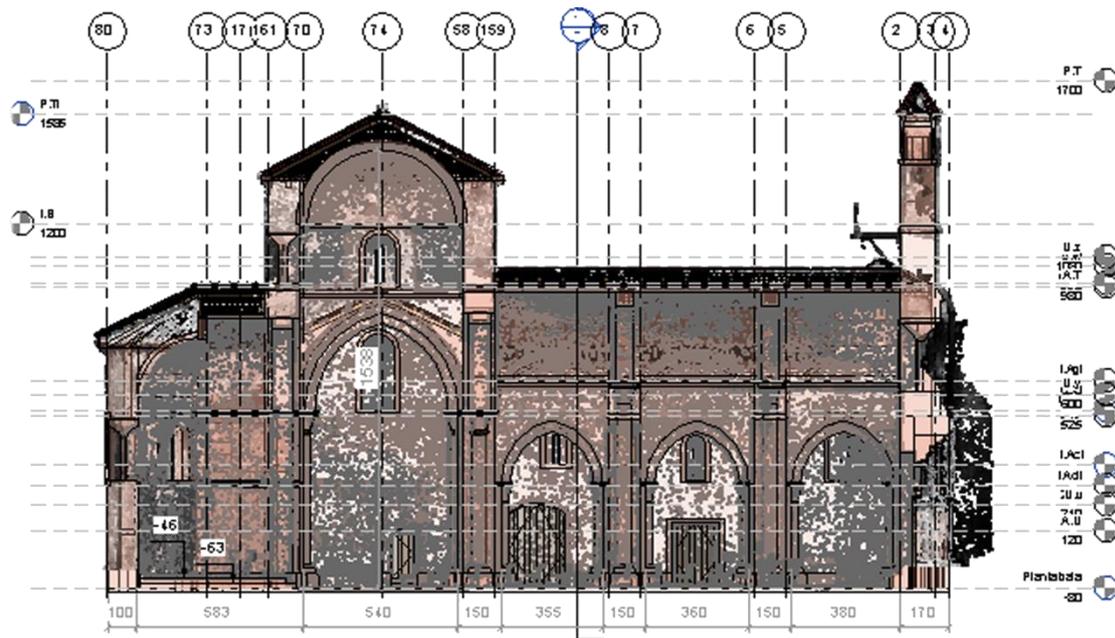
Corte longitudinal con los detalles constructivos en transparencia.
